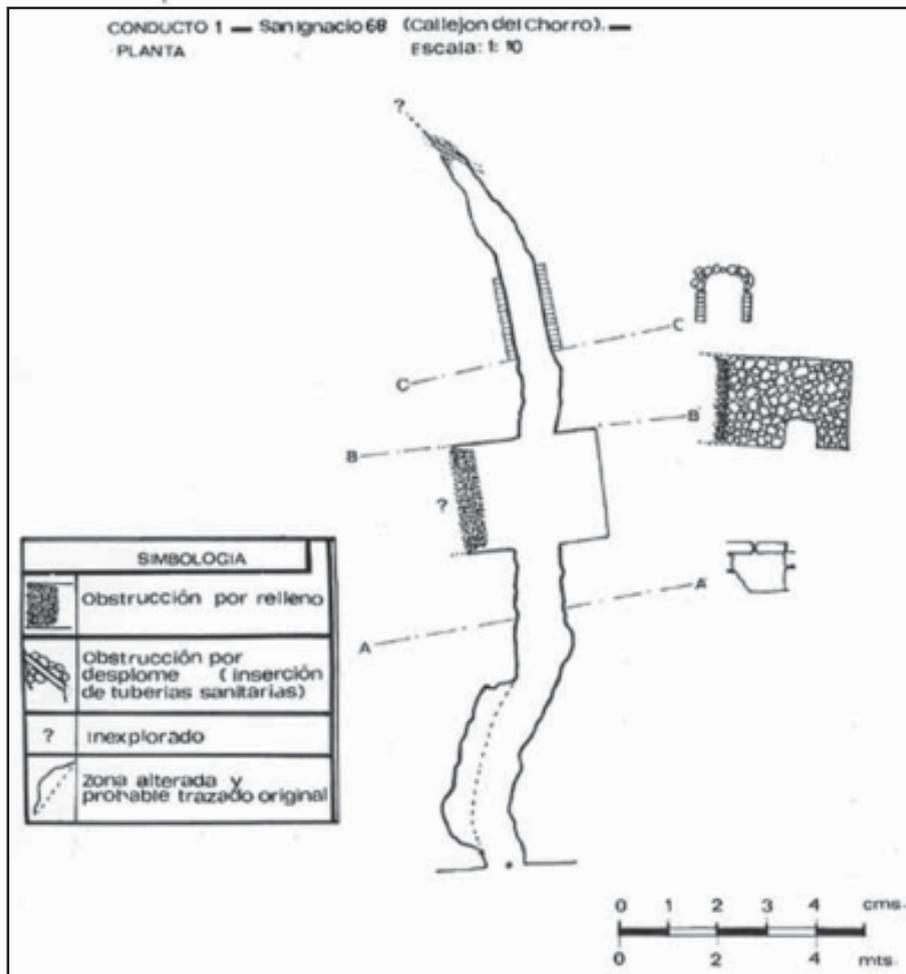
Croquis en planta del conducto excavado en San Ignacio No. 68, Habana Vieja.
